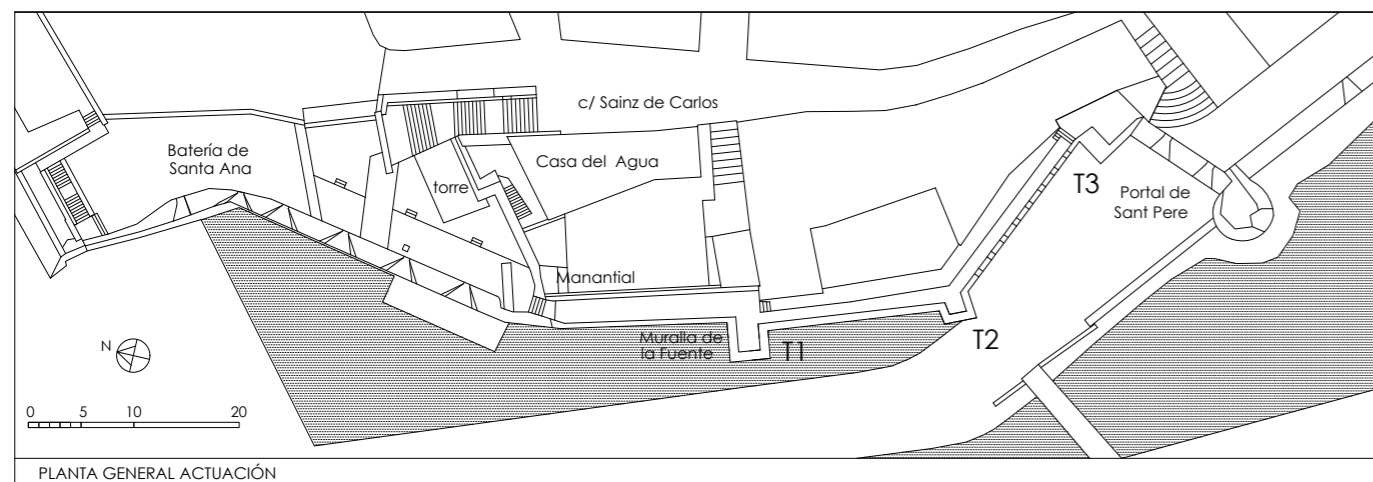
Planta del Proyecto de intervención sobre la batería de Santa Ana y la muralla de la Fuente de Peñíscola, con la solución en la que se integran los elementos localizados. (MJB 2000).
